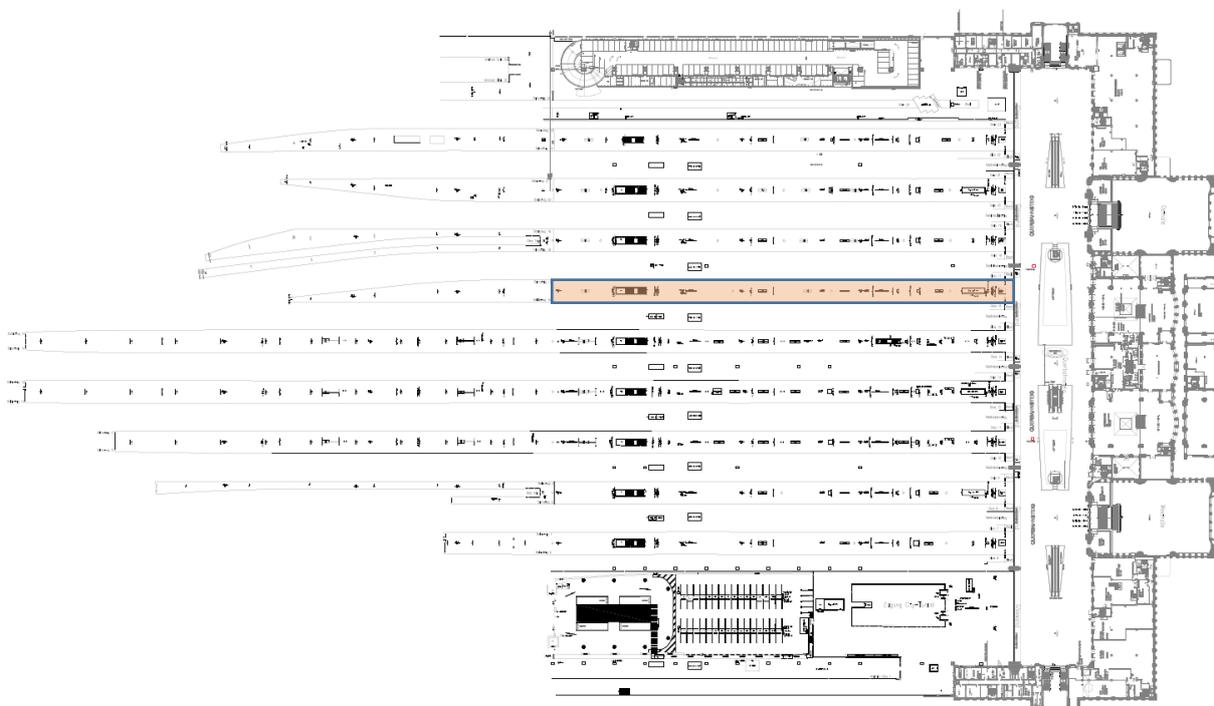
Grundriss des Bahnhofs Leipzig mit Kennzeichnung des Hallenbereichs von Gleis 17
